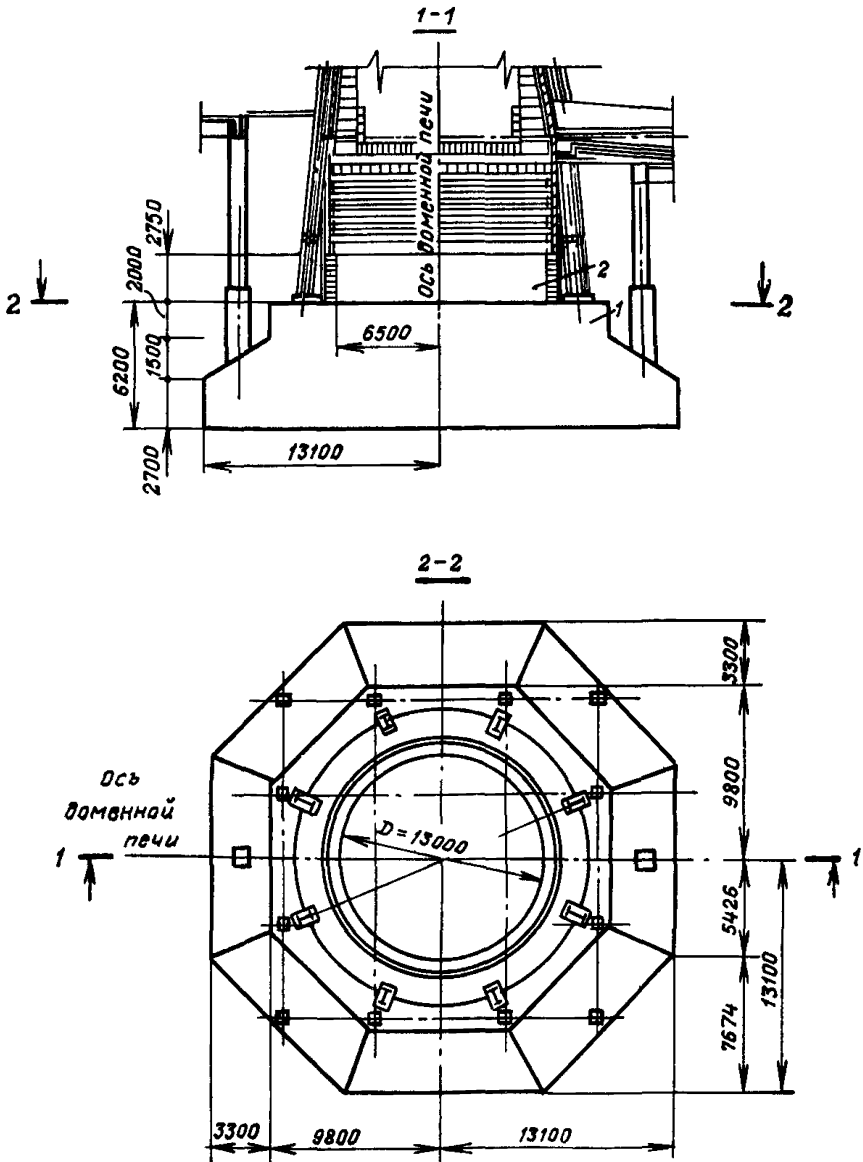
Разрез и план фундамента доменной печи объемом 3200 м<sup>3</sup>
